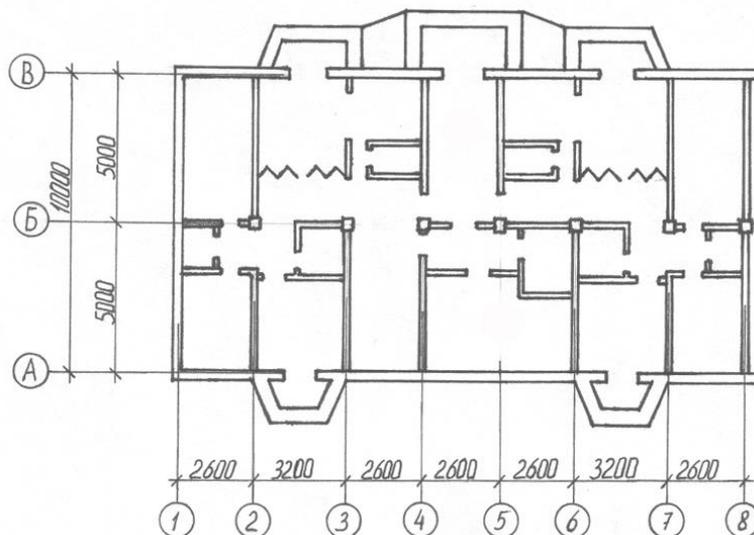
План пятого этажа (2-й вариант проектной разработки)
